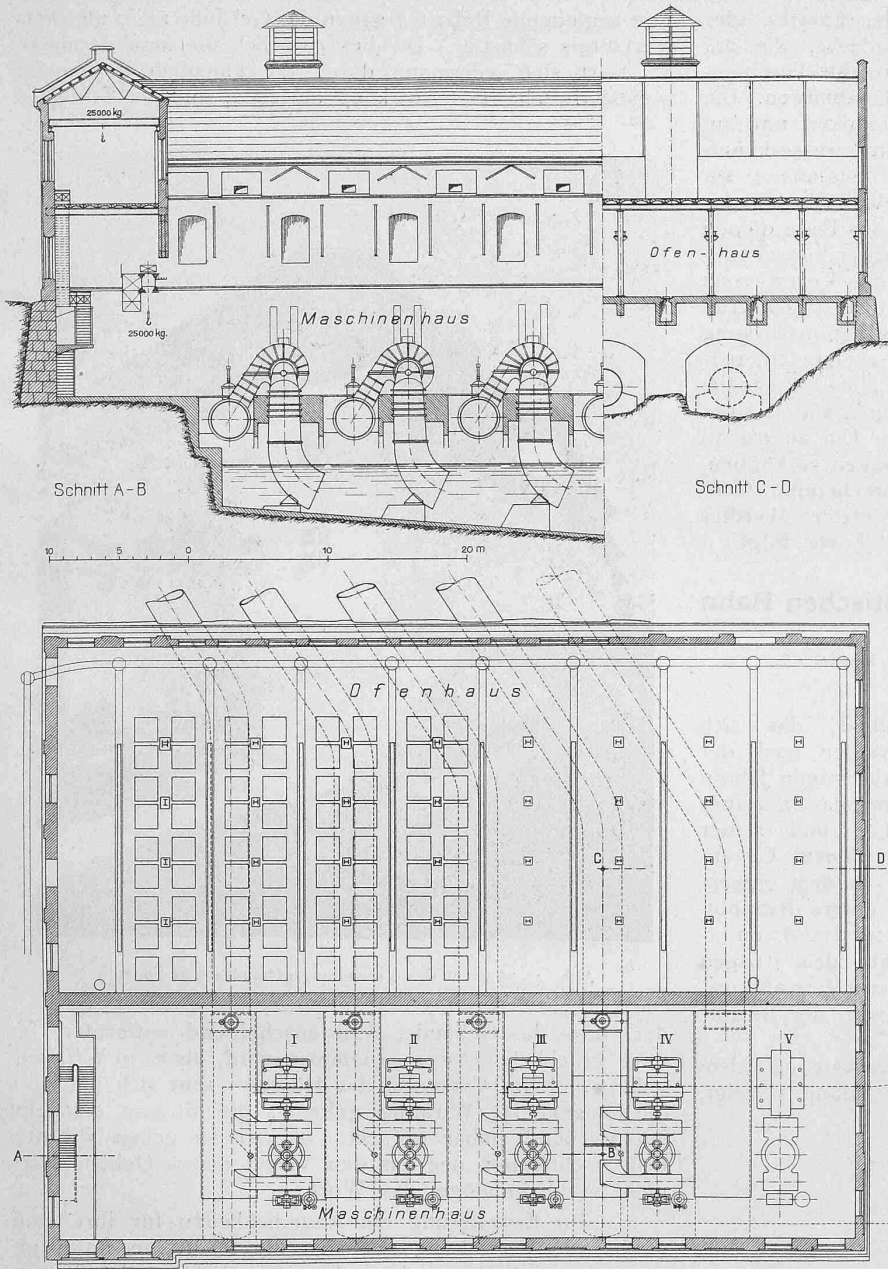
Grundriss; Abb. 13. Längsschnitt A-B, C-D des Maschinenhauses. — 1:500.
